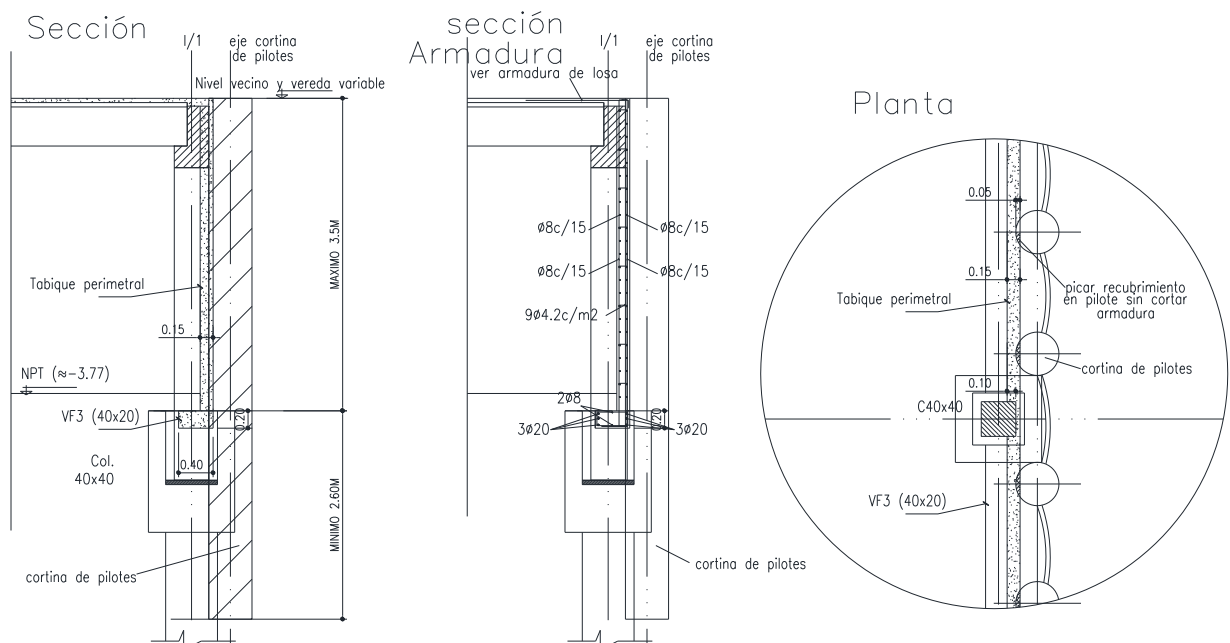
Detalles estructurales de los tabiques perimetrales.
